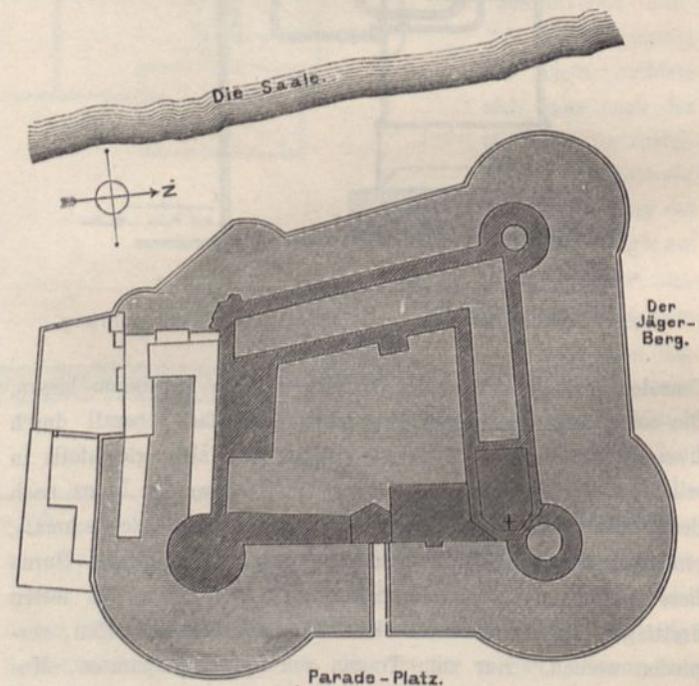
Moritzburg in Halle a.S. Lageplan.
